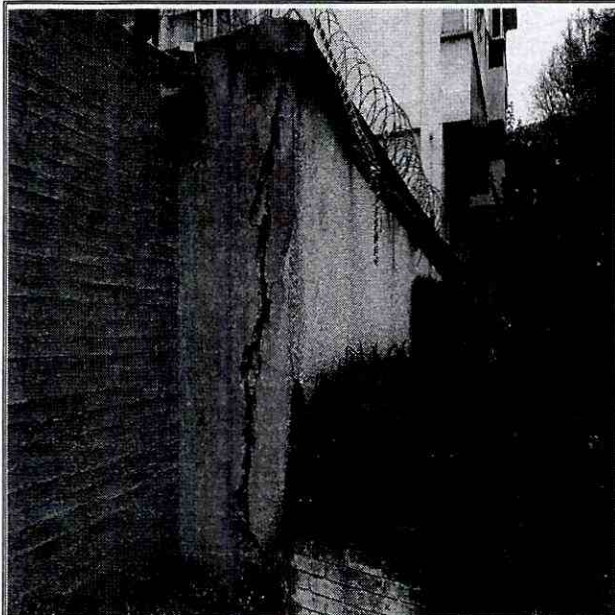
Afectación en muro perimetral costado occidental y apuntalamiento
